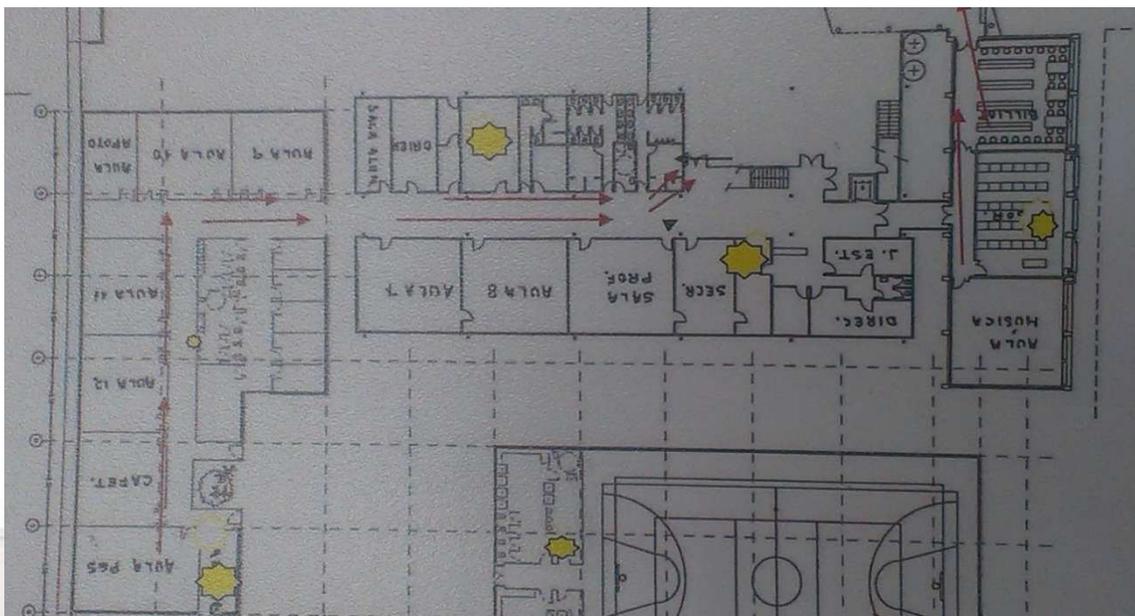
Recorridos de evacuación según el Plan de Autoprotección del I.E.S La Campiña
